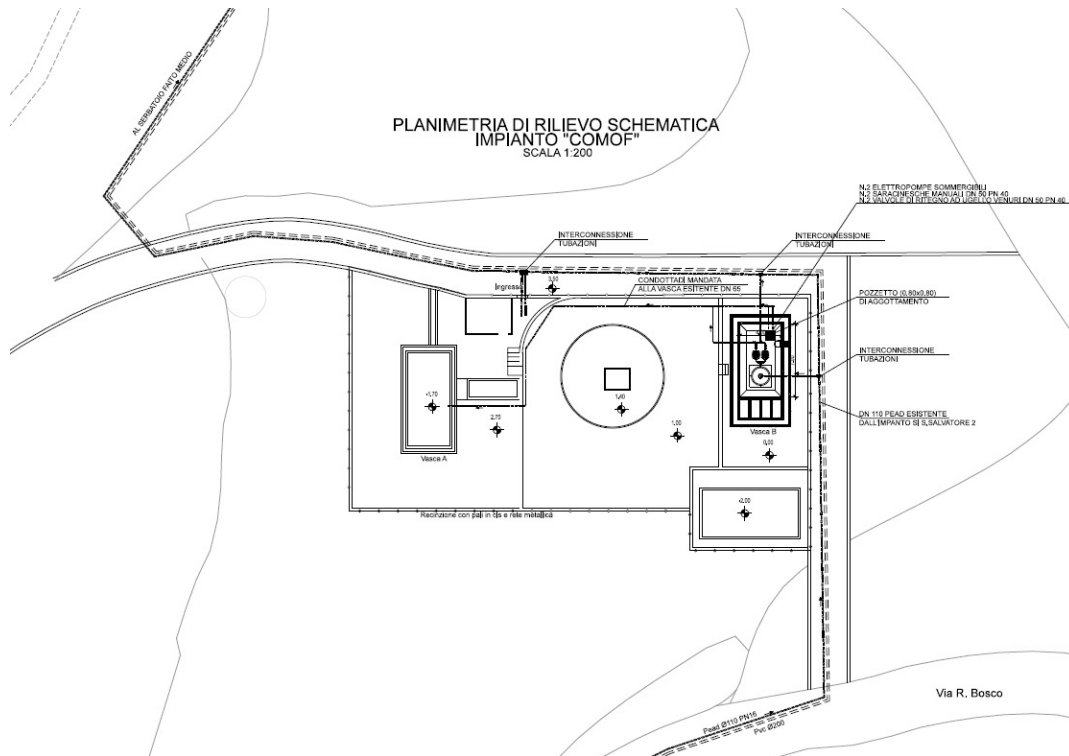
Planimetria dell'intervento previsto in località Villaggio Monte Faito (impianto di sollevamento realizzato all'interno delle strutture dell'impianto "Co.Mo.F." preesistente)
